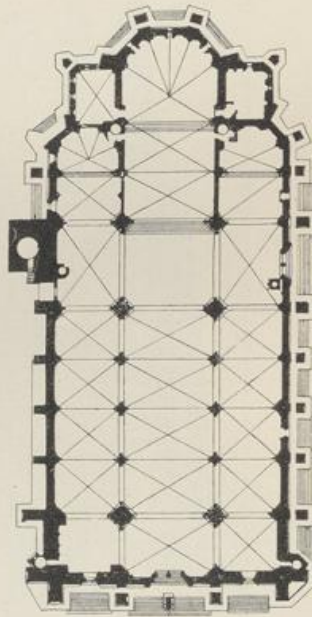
Grundriss des Domes zu Regensburg.
